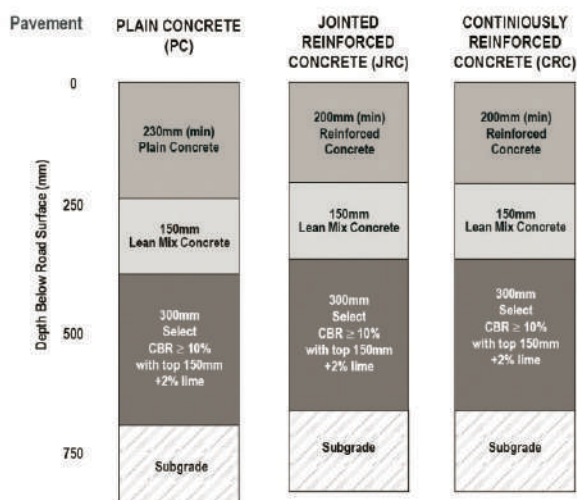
Structură rutieră tipică din beton simplu, beton armat cu rosturi (RC) și armat continuu RC pentru drumuri grele (Helmus, 2006)
